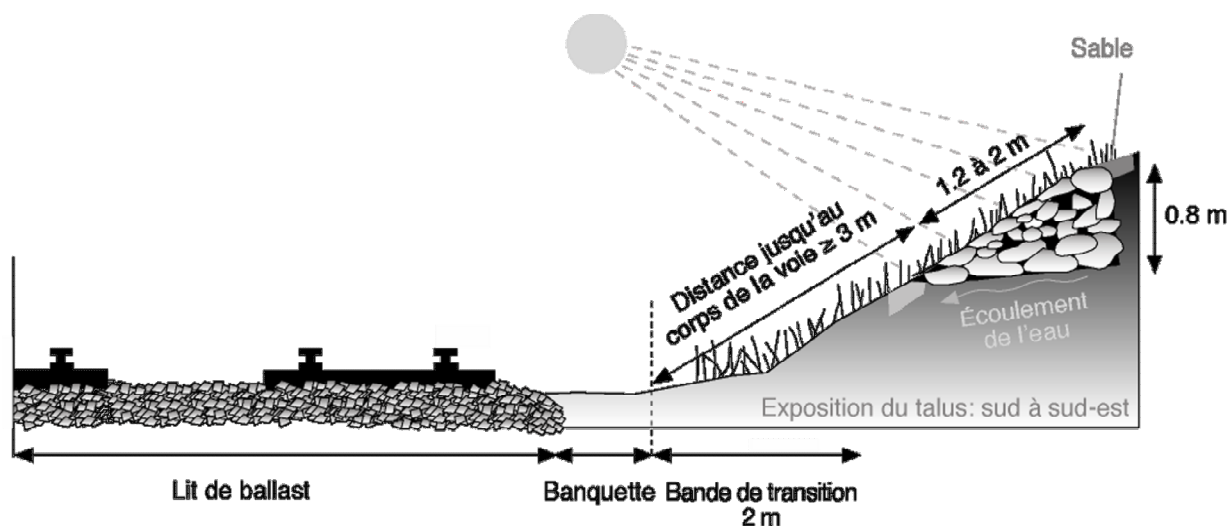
coupe transversale d'un empierrement affleurant. Structure de base en talus.
